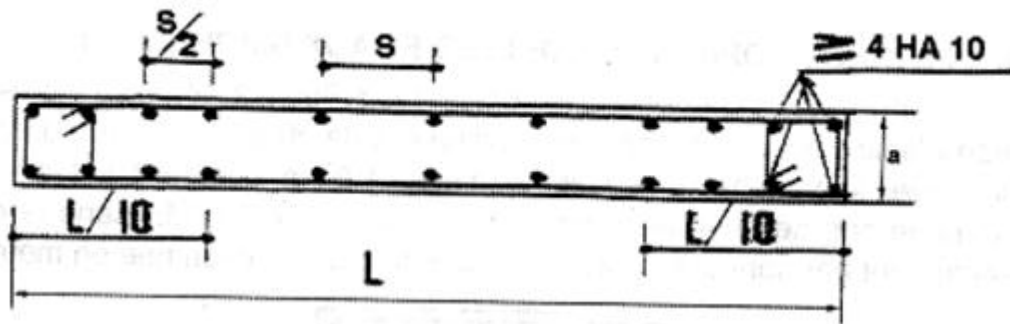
Disposition des armatures verticales dans les voiles.
